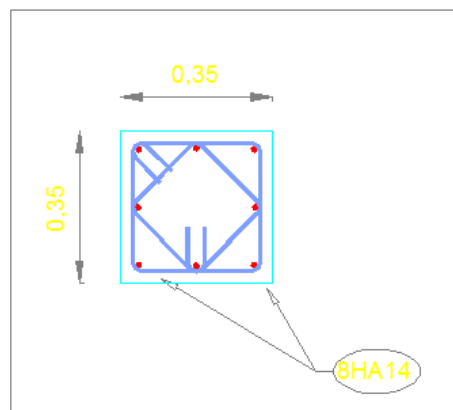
Disposition des armatures dans les poteaux
